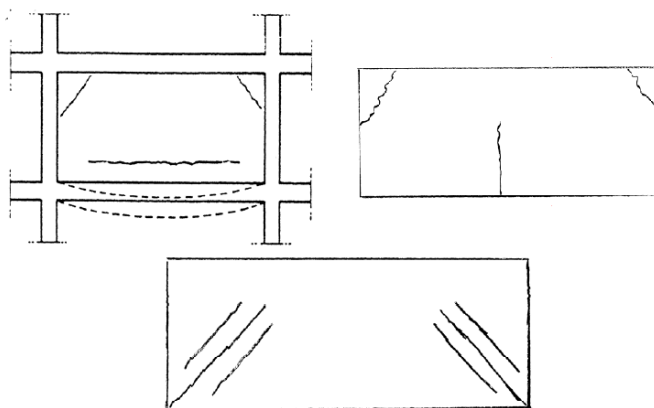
Fissuração devido à deformação do pavimento inferior (1º lado esquerdo); superior (1º do lado direito), a ambos (a de baixo) [1]
